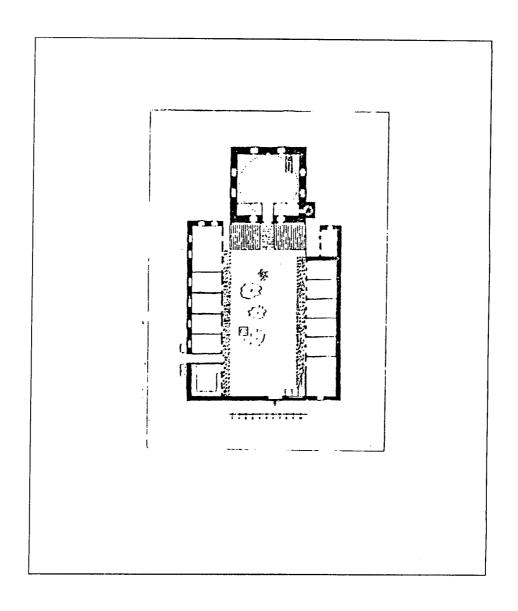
مسقط أفقي لمسجد الفاتح بعد تجديده (عن : جابرييل) .
